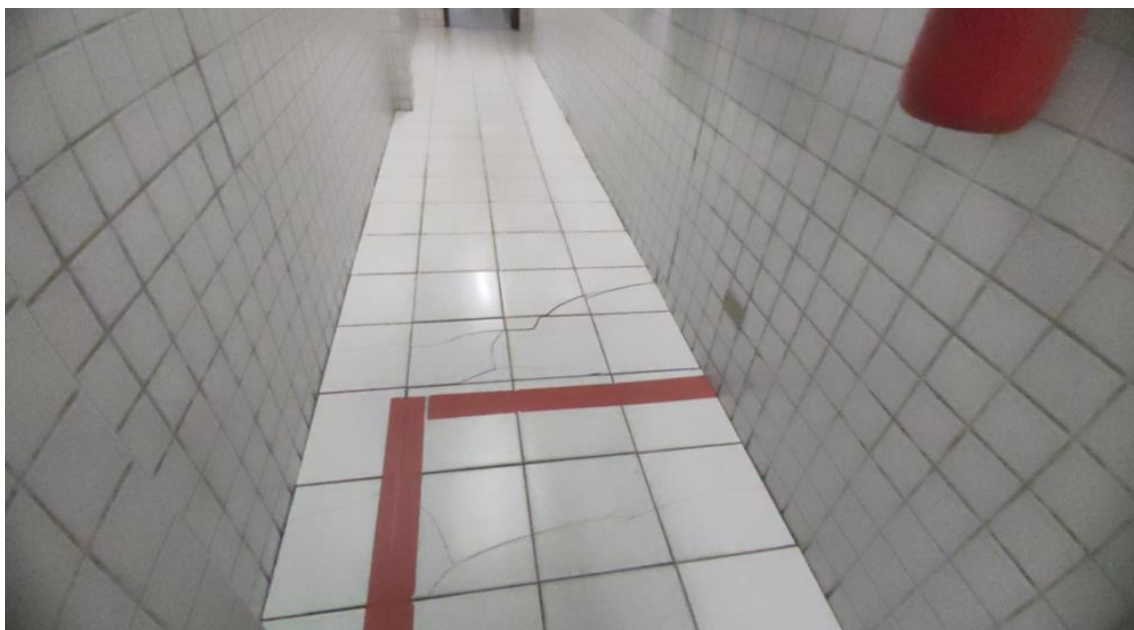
Fissuras no piso cerâmico em corredor da área operacional
